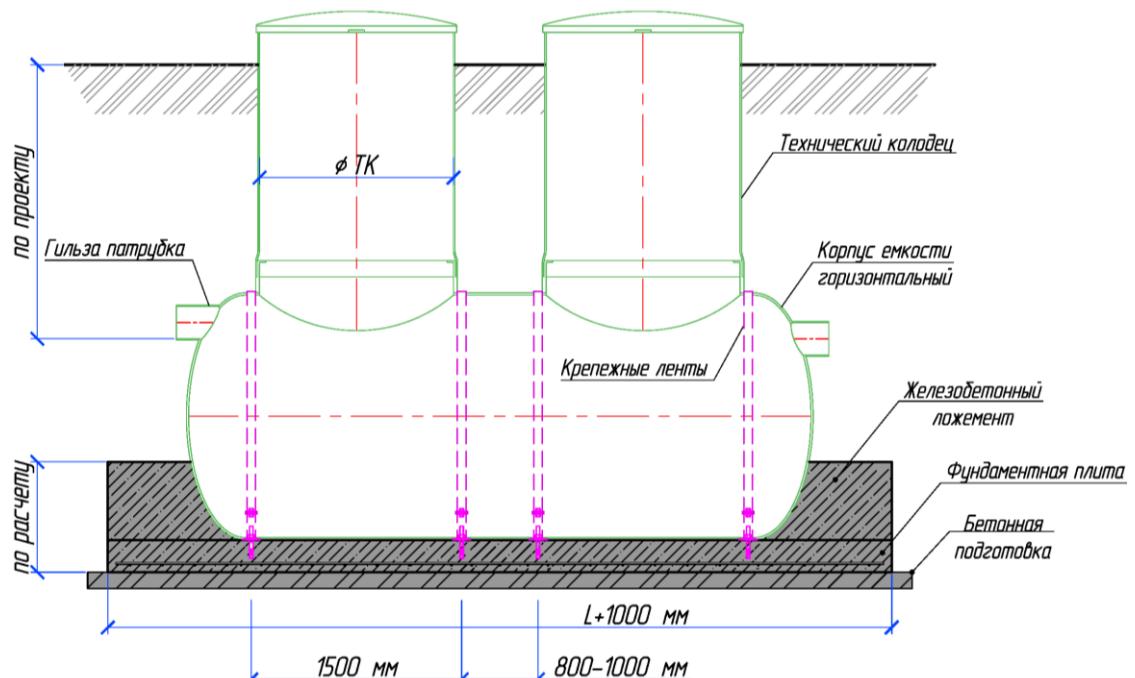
Крепление горизонтального изделия к фундаментной ж/б плите
